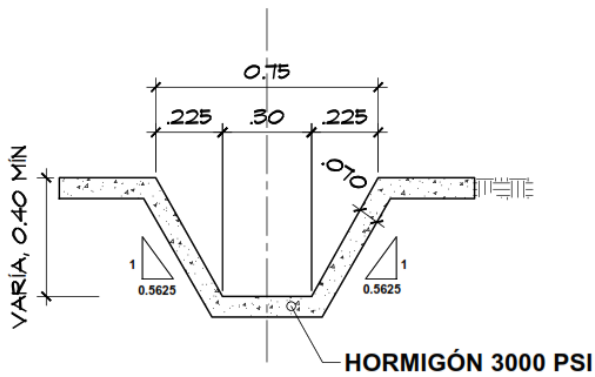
Detalle típico de las calles de 13.60 m de ancho
